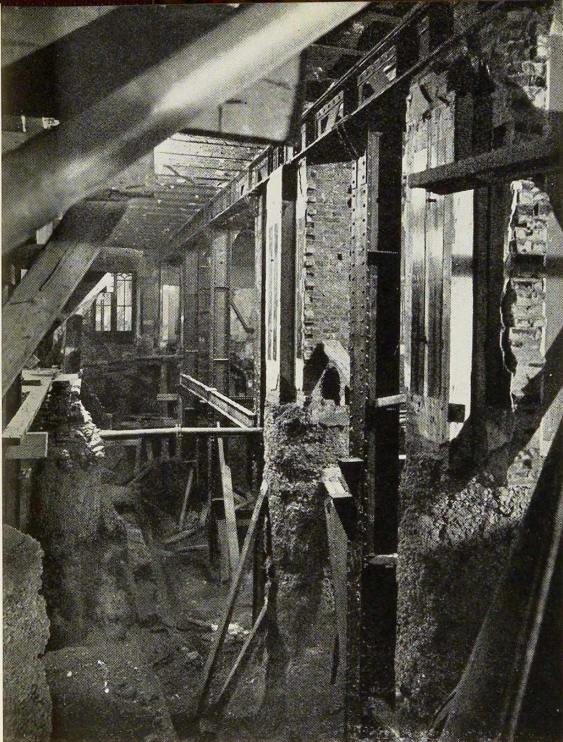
Détail de reprise en sous-œuvre. A remarquer l'excavation nouvelle faite pour le second sous-sol et les anciens piliers en maçonnerie.
